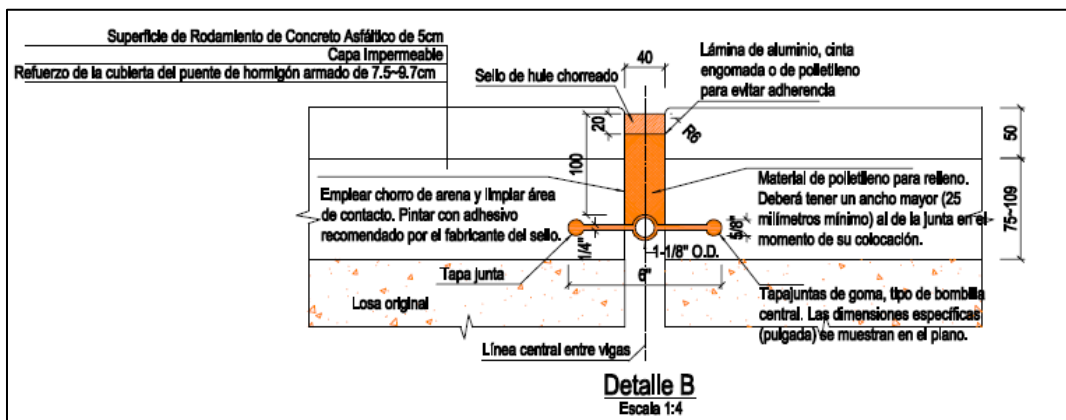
Detalle constructivo de sello ubicado sobre la Pila n.º 1 en el espacio entre vigas
